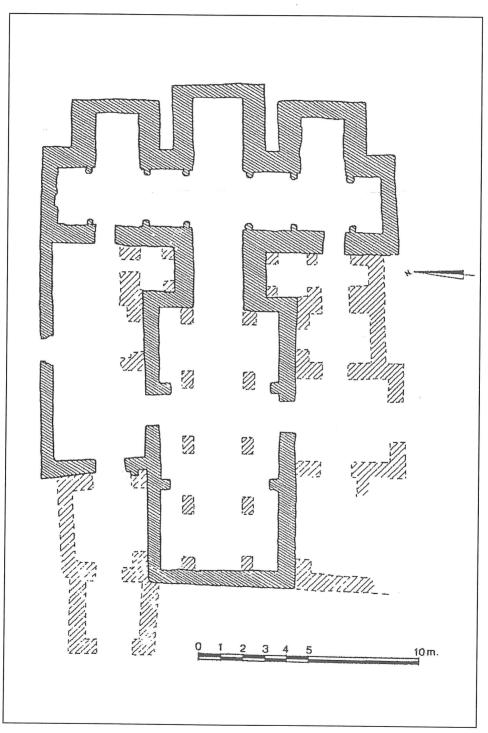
Santa Lucía del Trampal. Alcuéscar (Cáceres). Planta (según: Caballero Zoreda).
